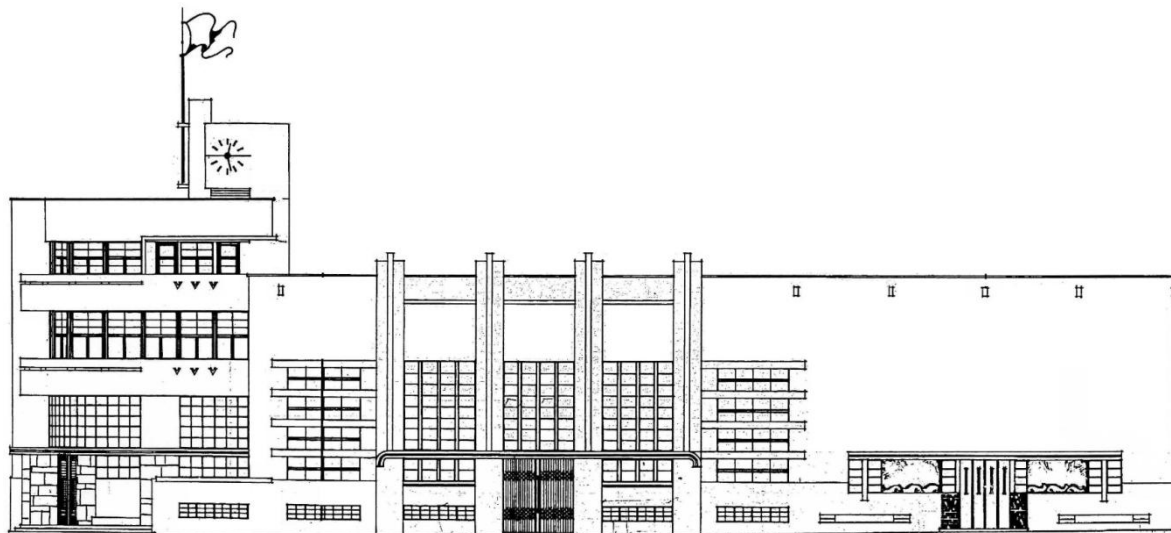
Alçado do projecto da fachada sobre a Alameda da Basílio Teles
